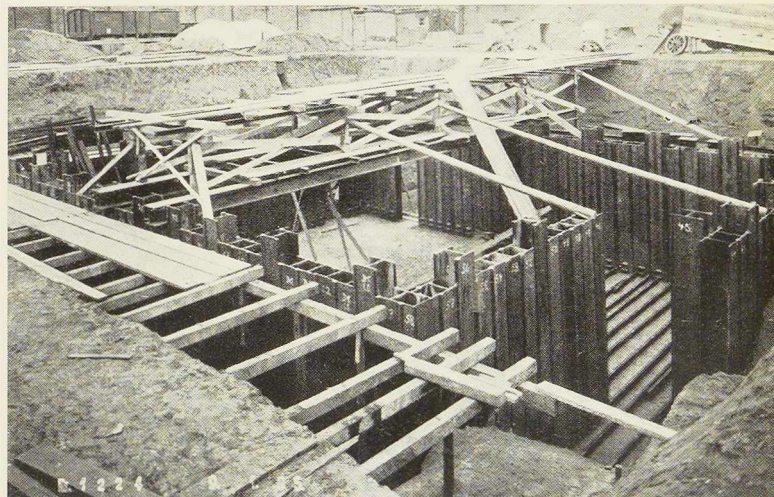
Construction d'un abri dont les parois sont en palplanches en caissons.
